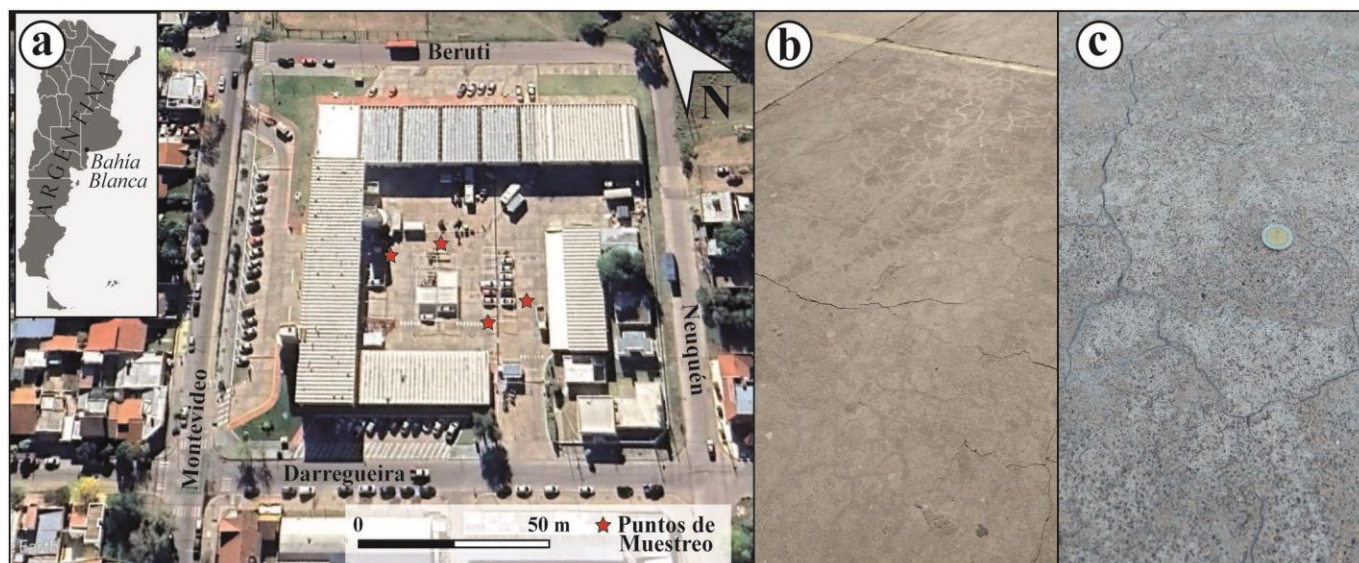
a) Ubicación del área de estudio, b) Vista de la losa de hormigón con fisuras en mapa, c) Detalle de la fisuración del hormigón (Escala moneda, diámetro = 23 mm)
